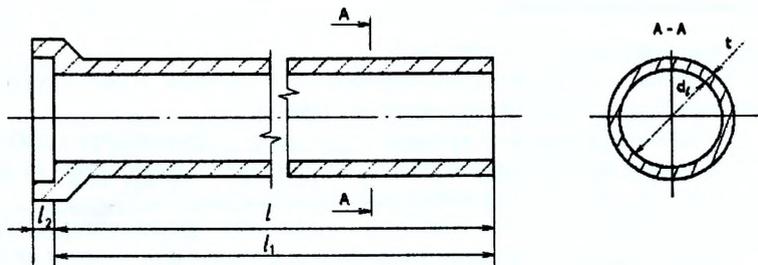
Общий вид труб типа Т(БТ) – железобетонных (бетонных) цилиндрических раструбных
